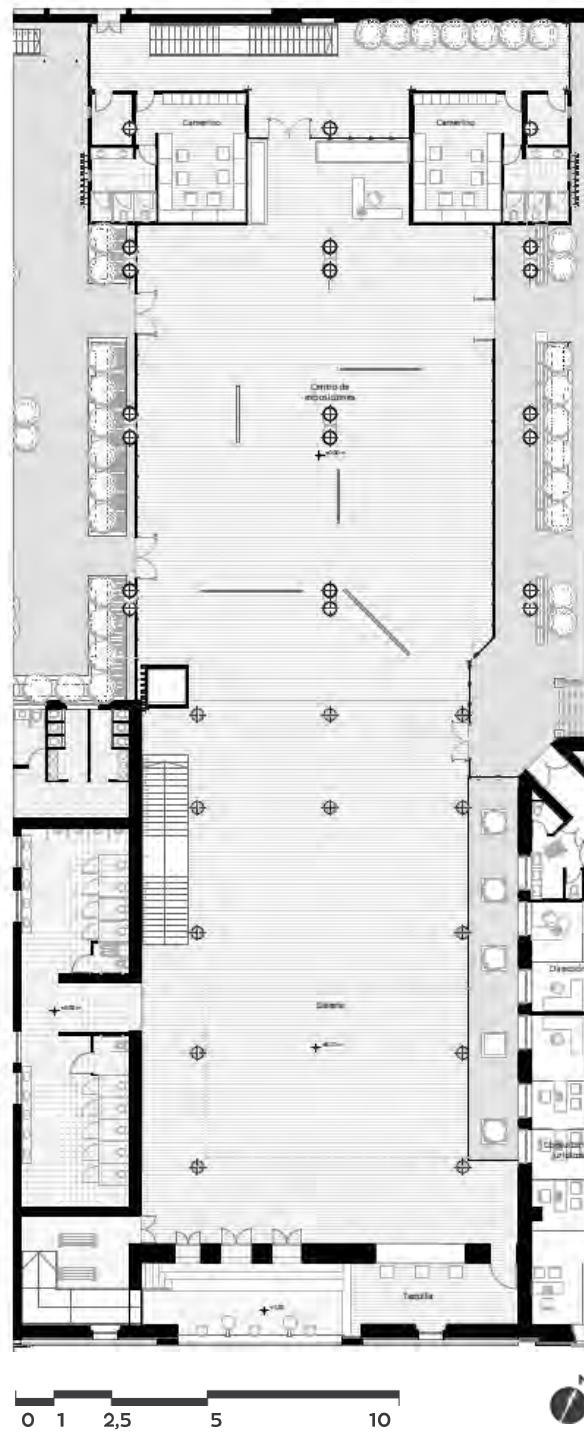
Planta Sala de Música primer piso. Fuente: Elaboración Propia.
